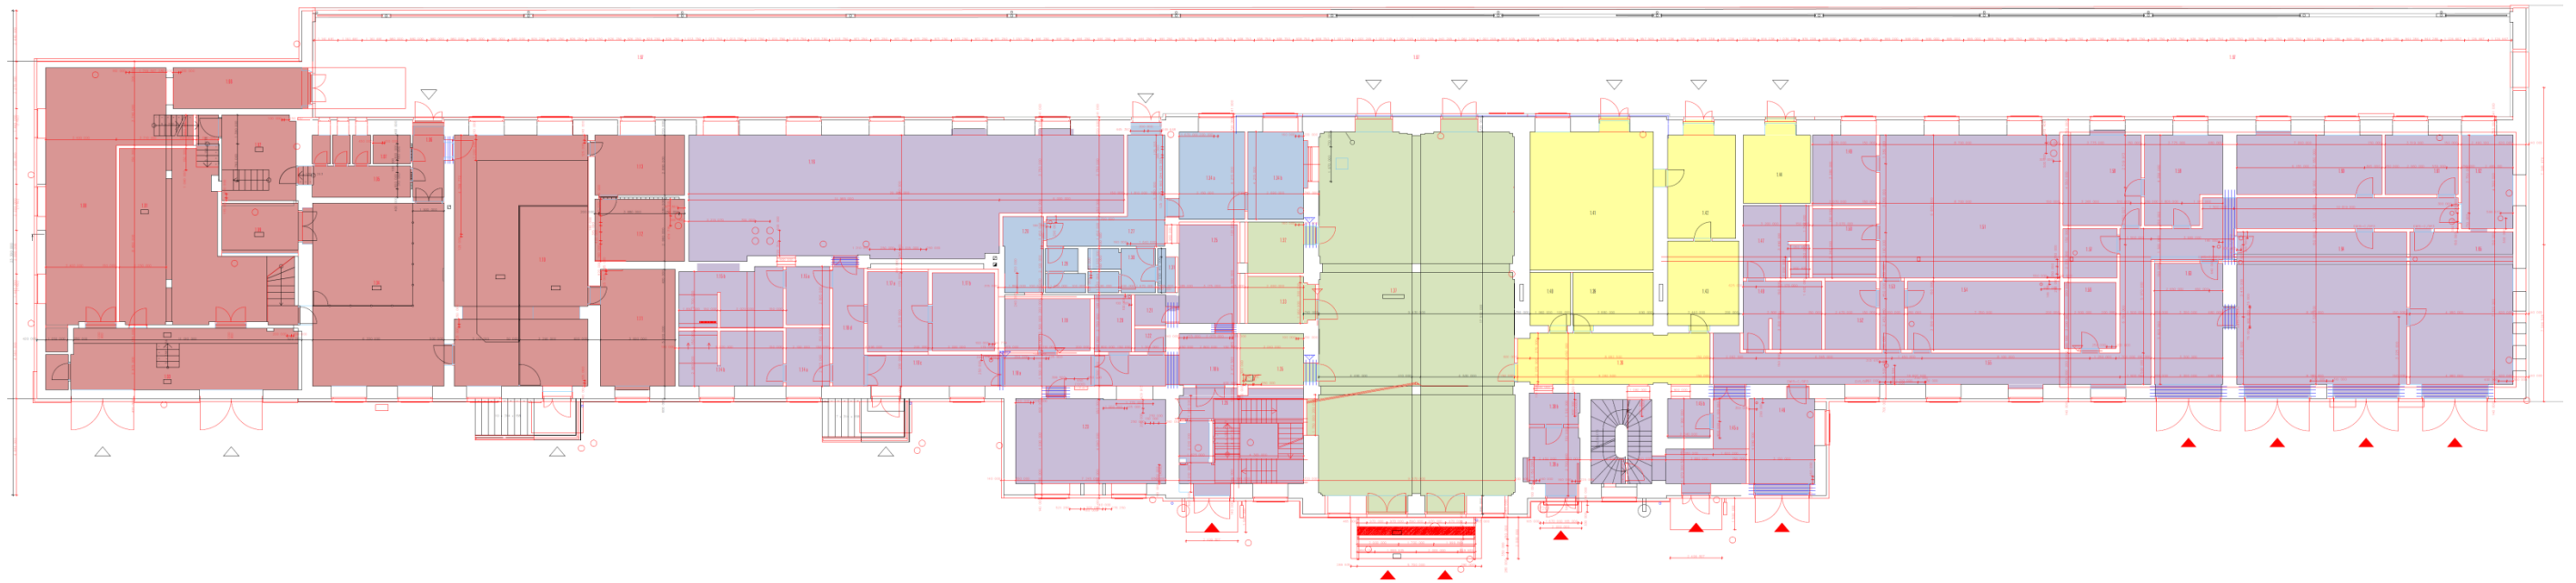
Půdorys nového stavu 1. PP s vyznačením využití jednotlivých prostor
